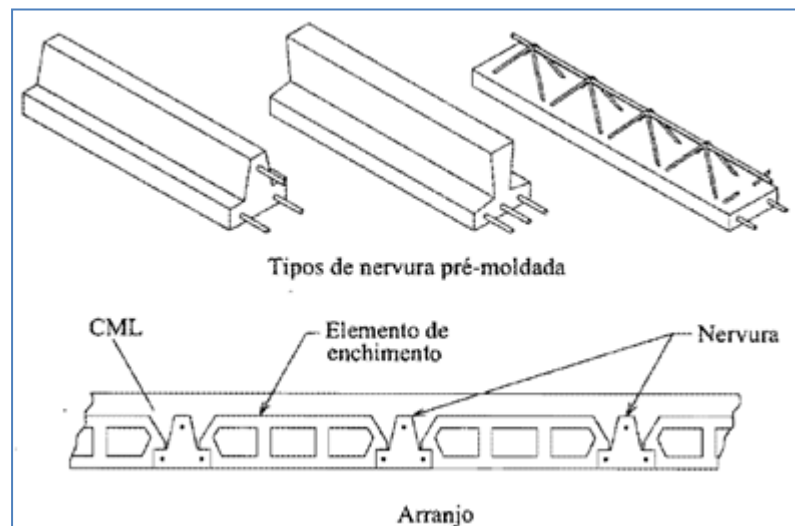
Lajes formadas por vigotas pré-moldadas (adaptado de EL DEBS (2000))
